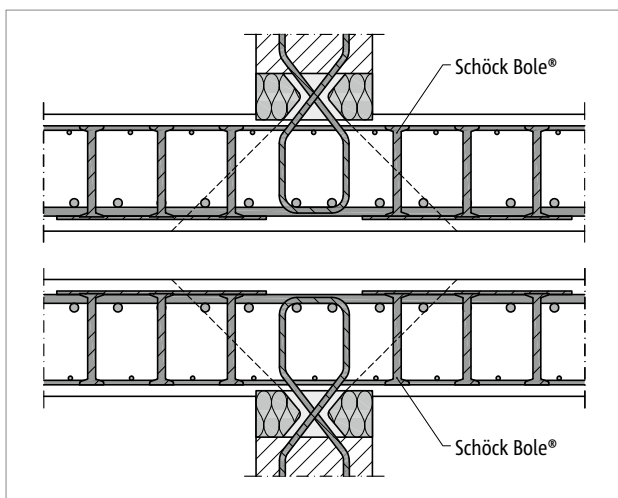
Schöck Sconnex® Typ W-N: Indirekte Lagerung der Schöck Sconnex®, mit Schöck Bole® bewehrt
